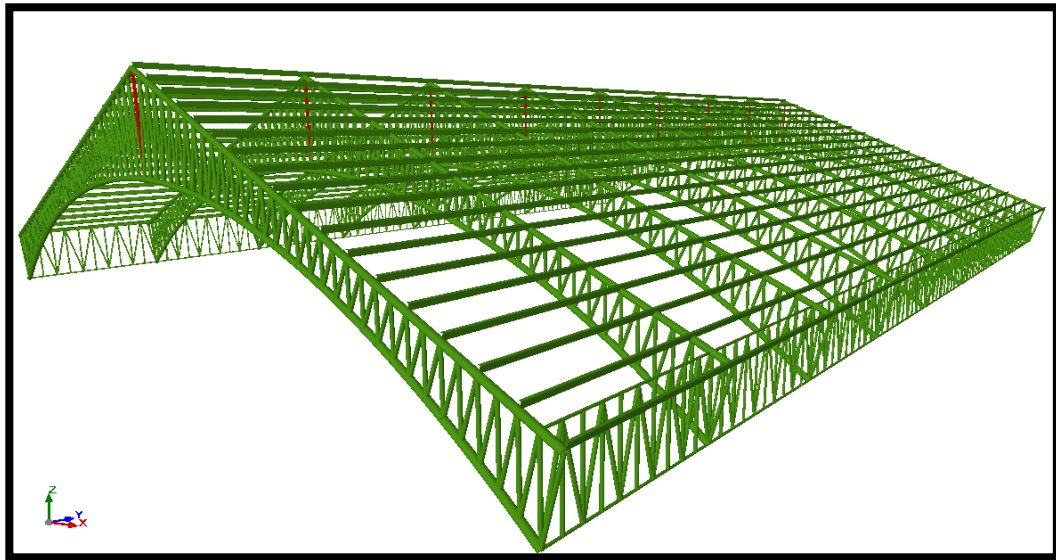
Modelo estructural de la cubierta tridimensional
